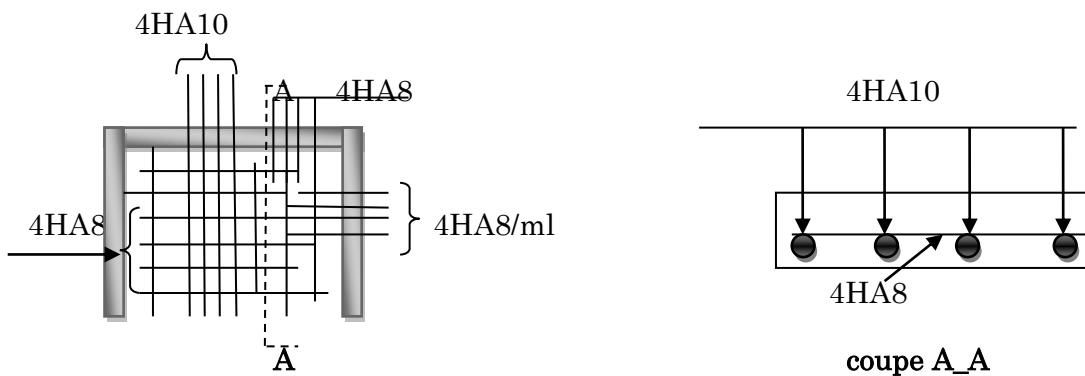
Schéma de ferrailage de la dalle sur trois appuis
